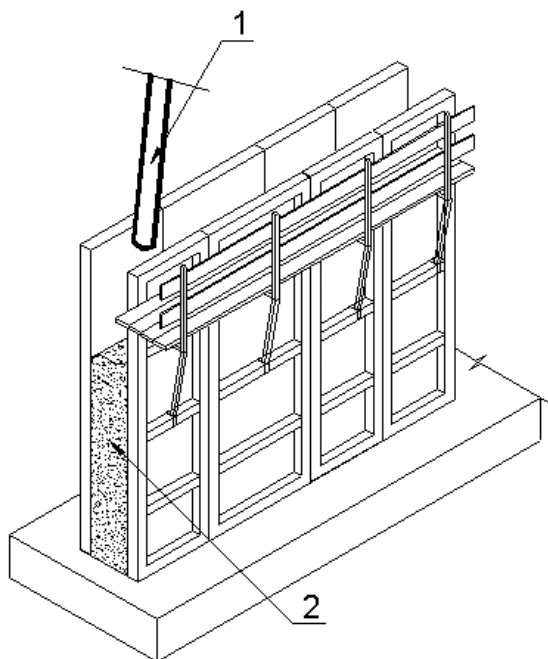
Укладка бетонной смеси в конструкцию автобетононасосом. 1 – хобот бетоновода, 2 – укладываемая бетонная смесь.
